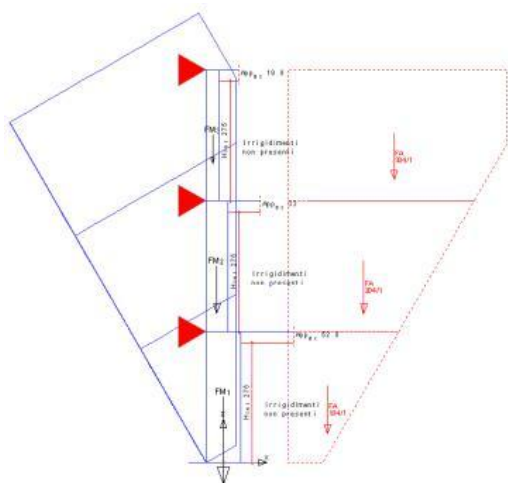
Flessione verticale attorno al 1° piano dell'intera parete
